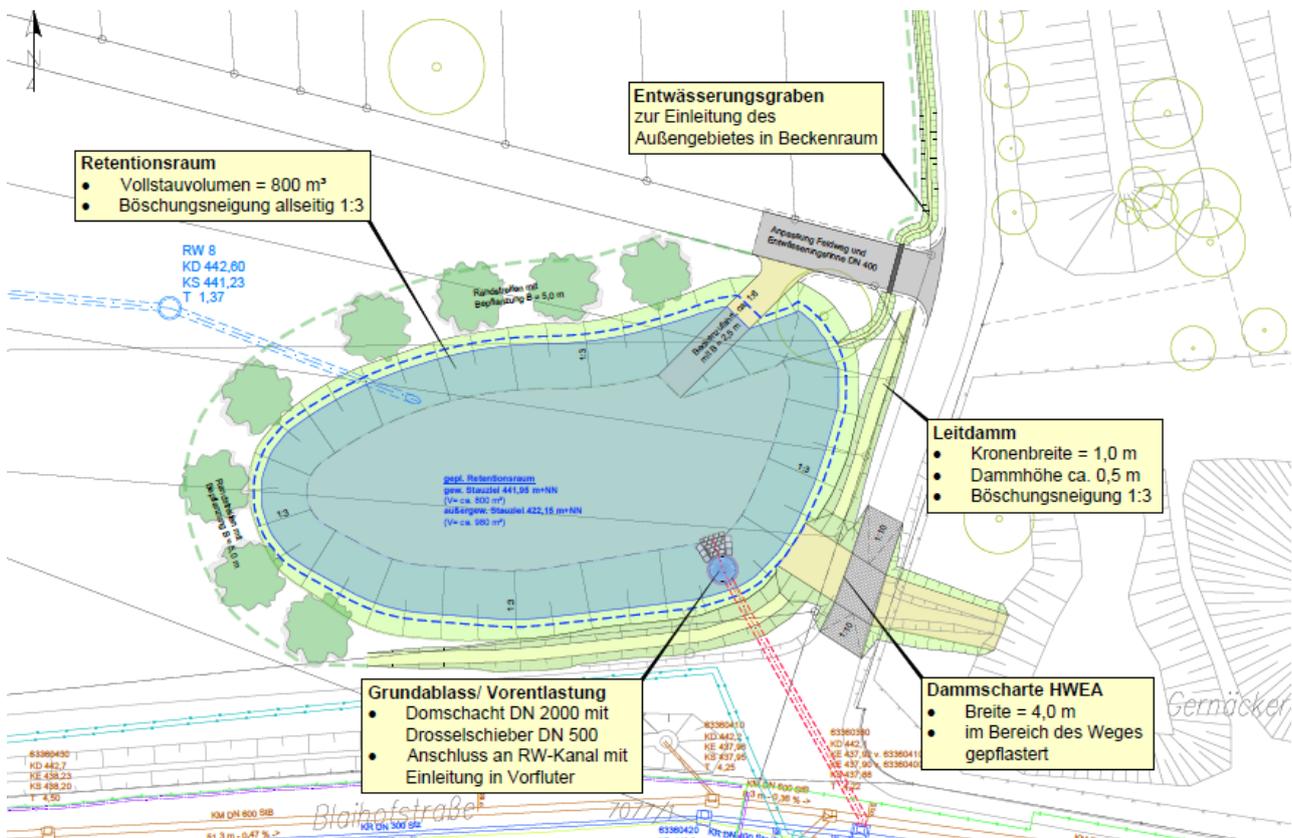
Lageplanausschnitt Planung [Büro Heberle]
